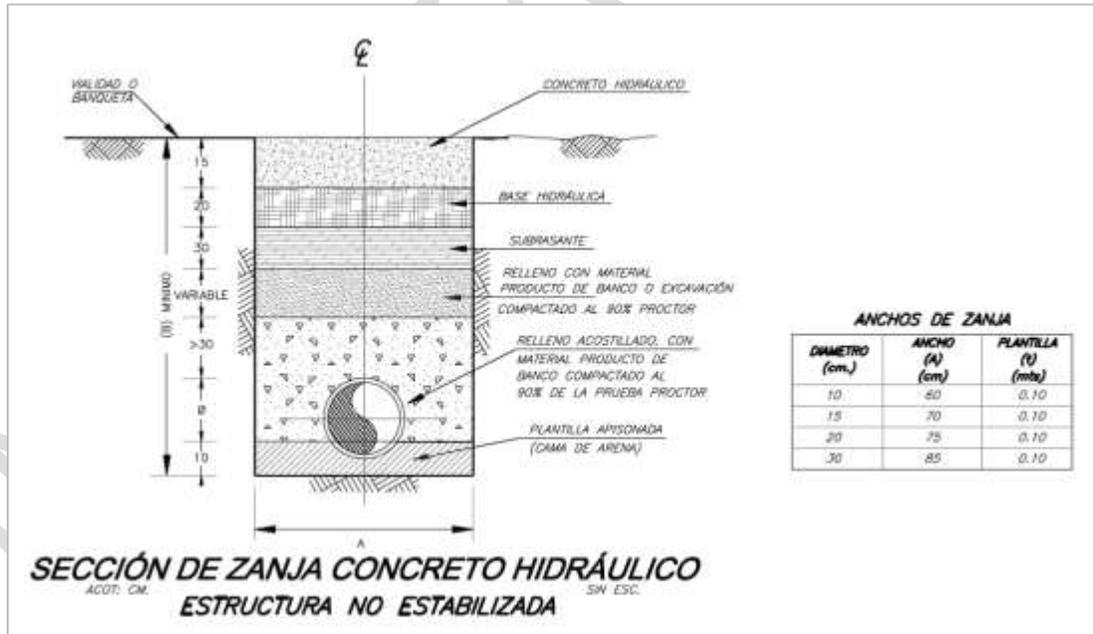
Sección tipo de zanjas para descargas sanitarias.
